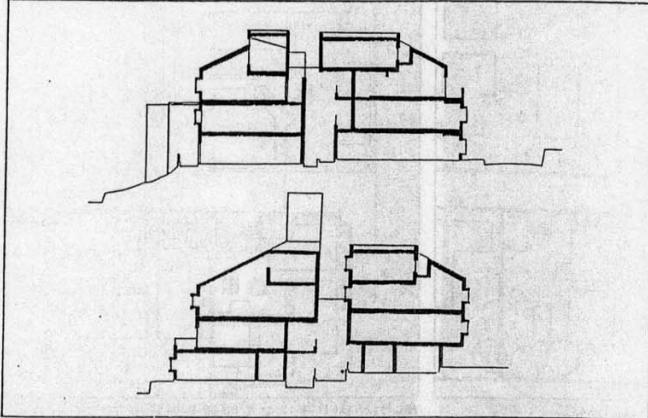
2棟の間に計画的に組み込まれた媒介領域 断面図 1:600
